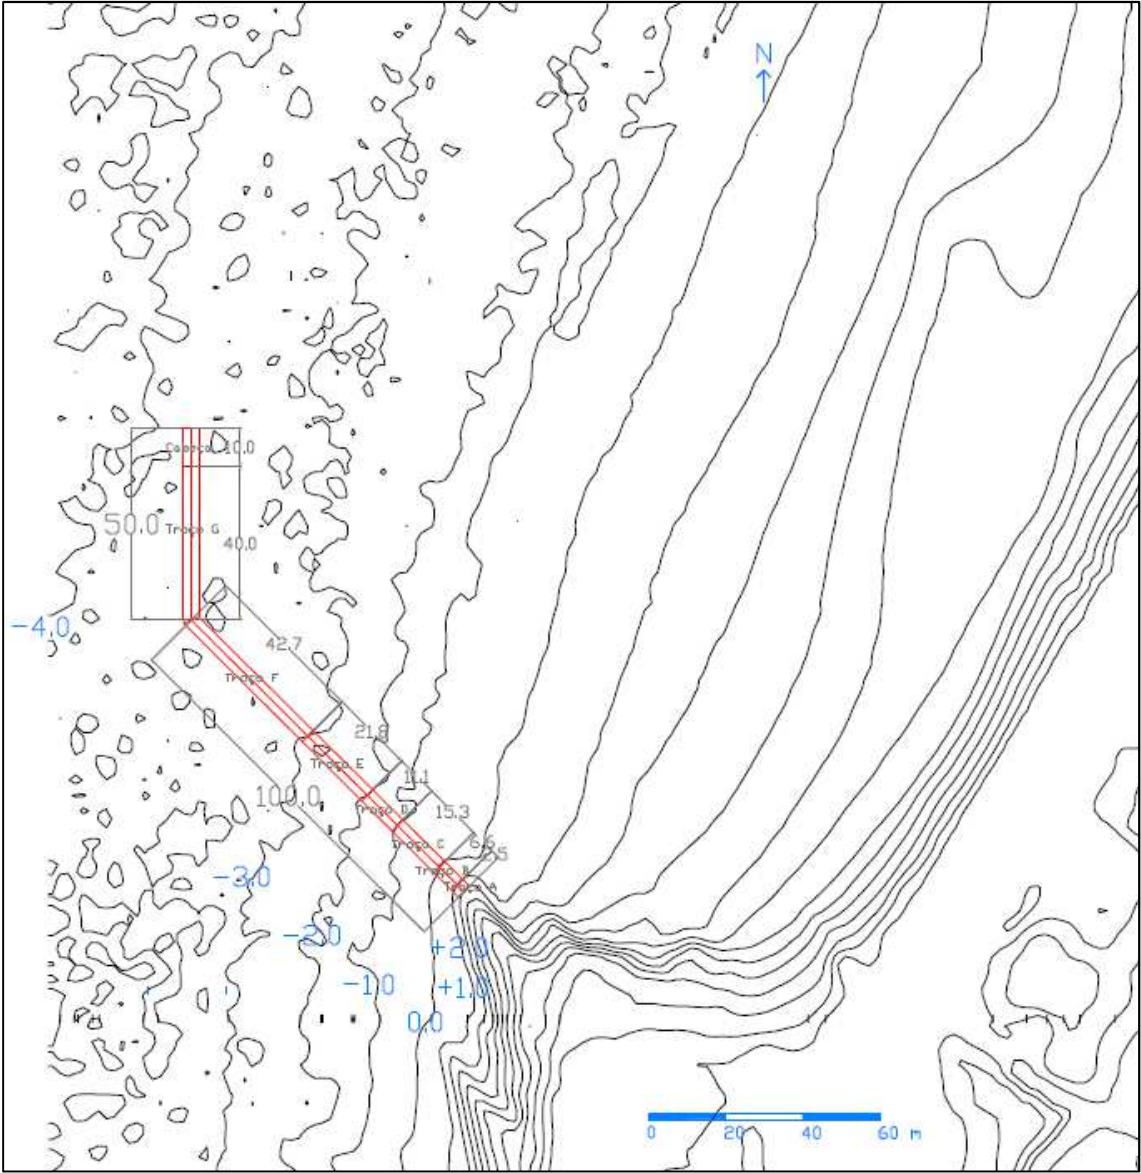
Planta de implantação de esporão em "L" com 150 m de comprimento
